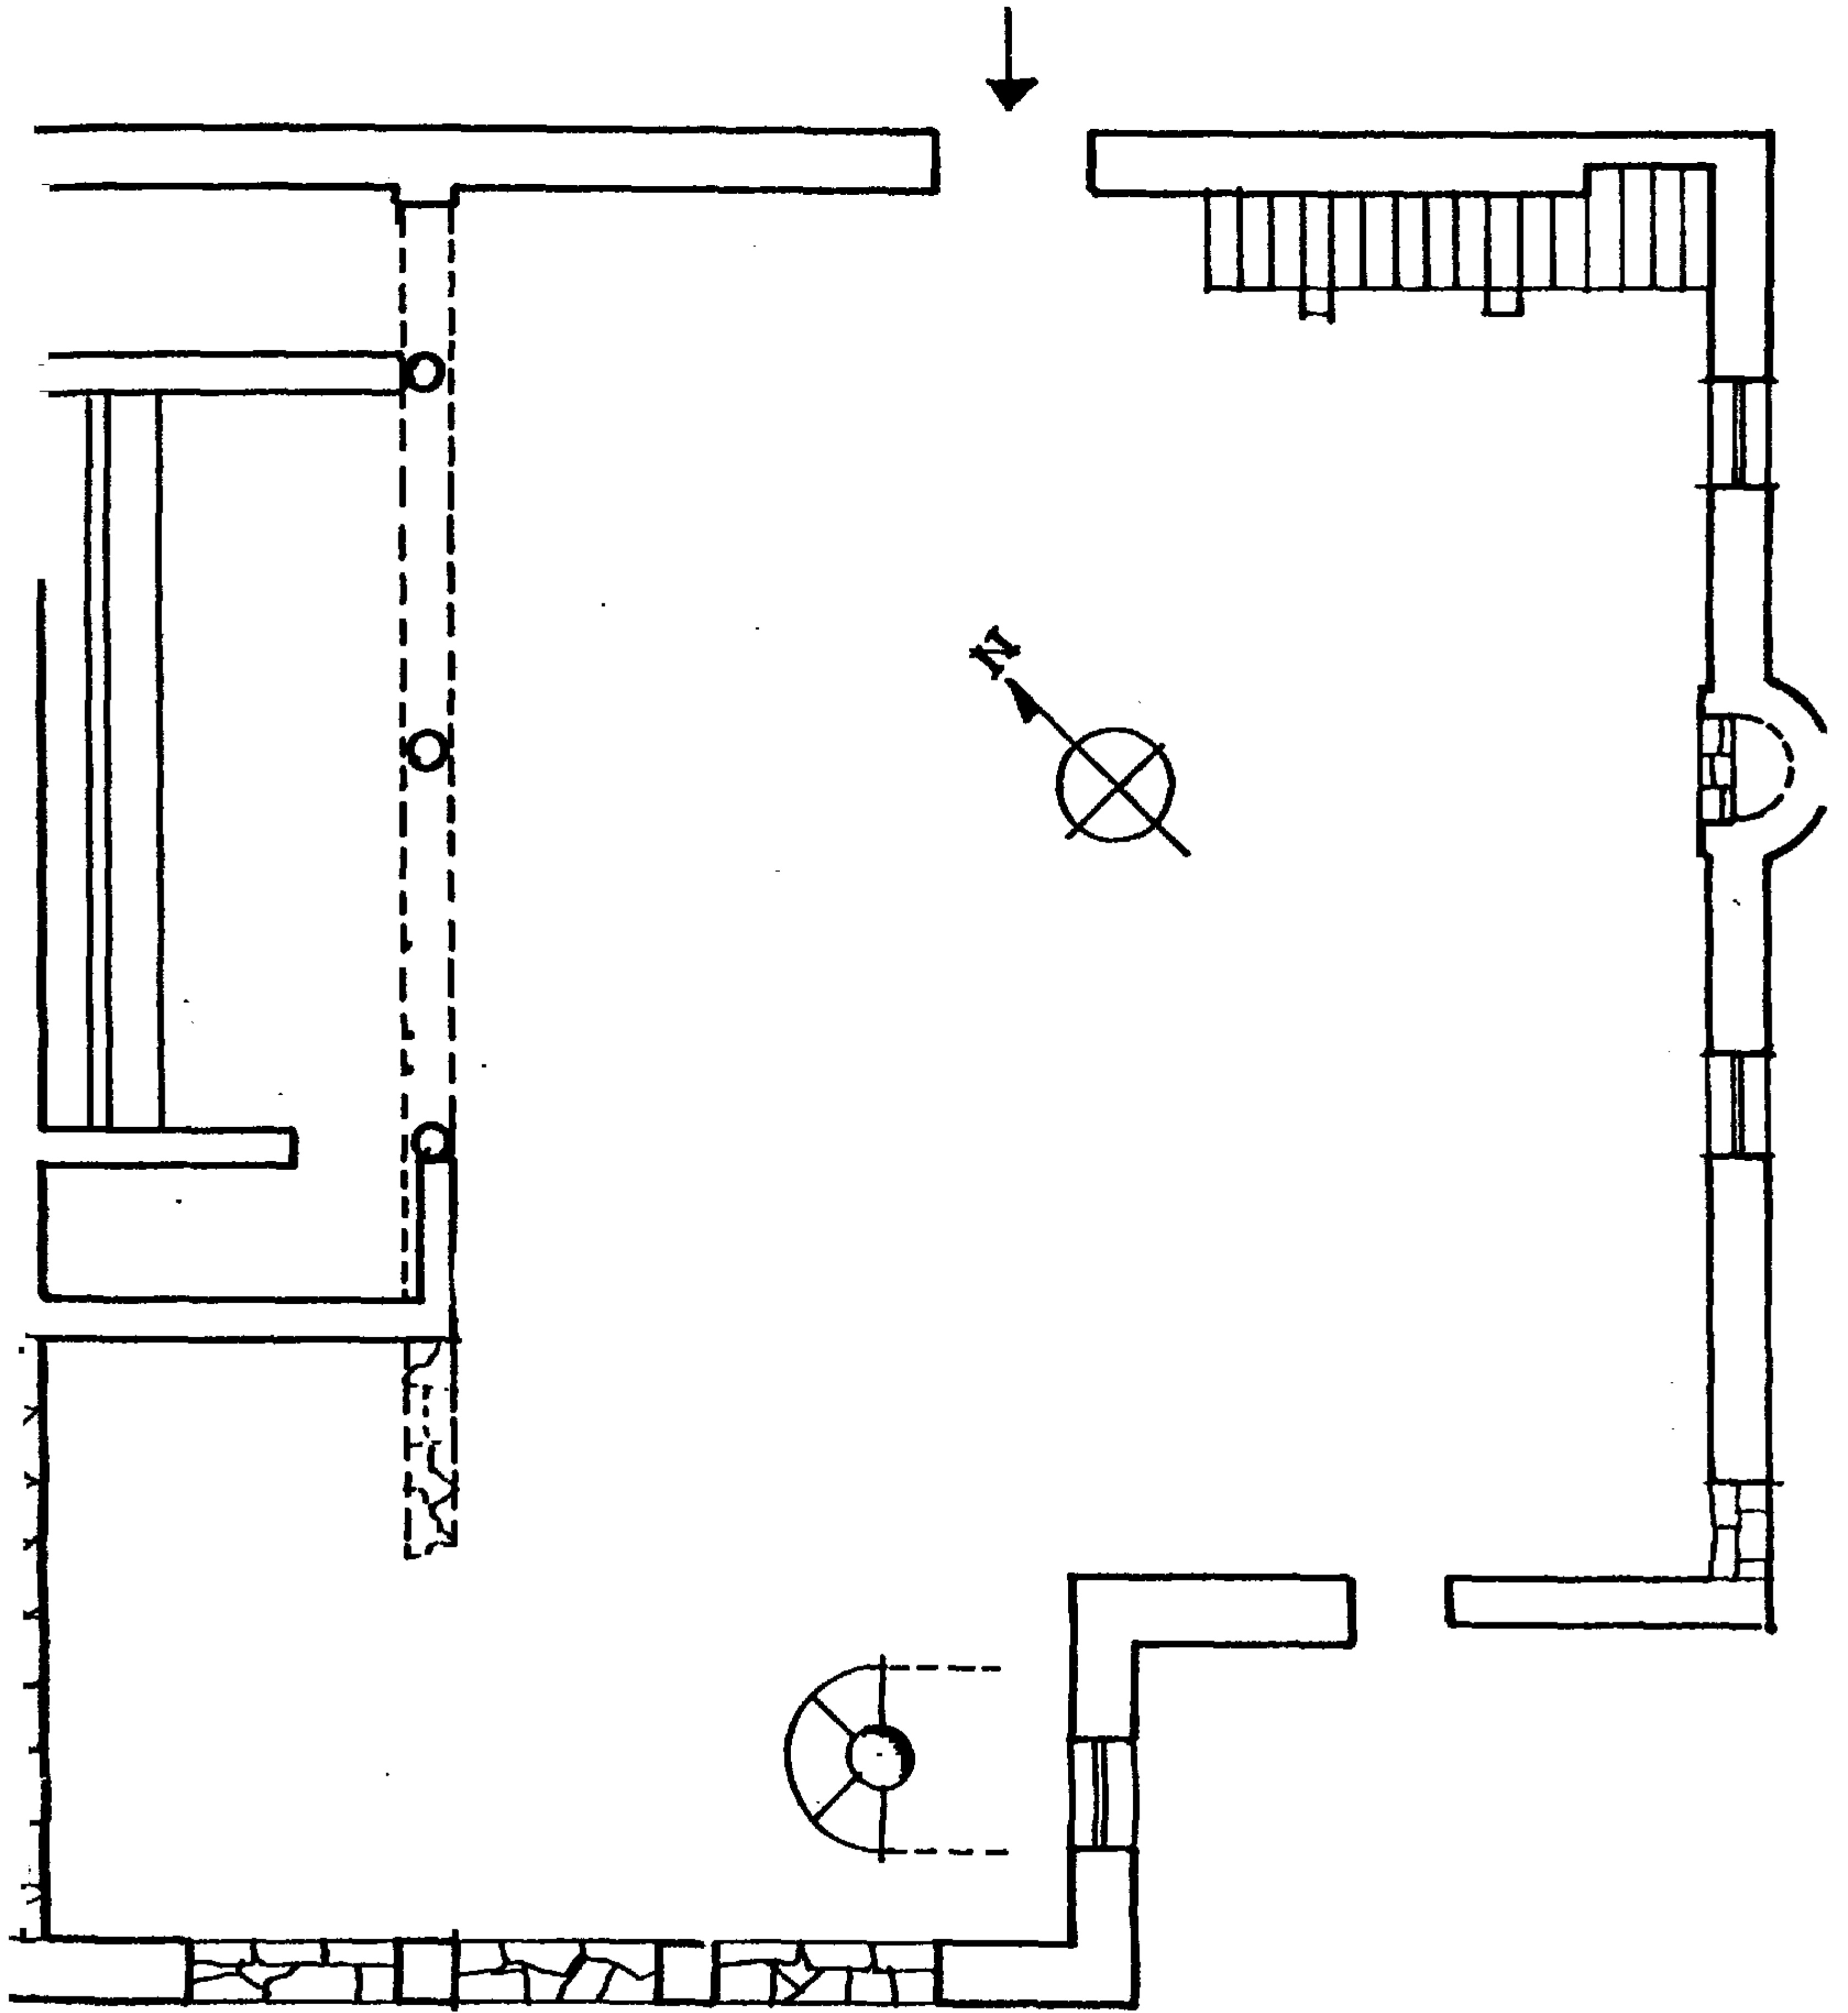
مسقط افقي لمسجد حمد الشتيوي عمل المؤلف
